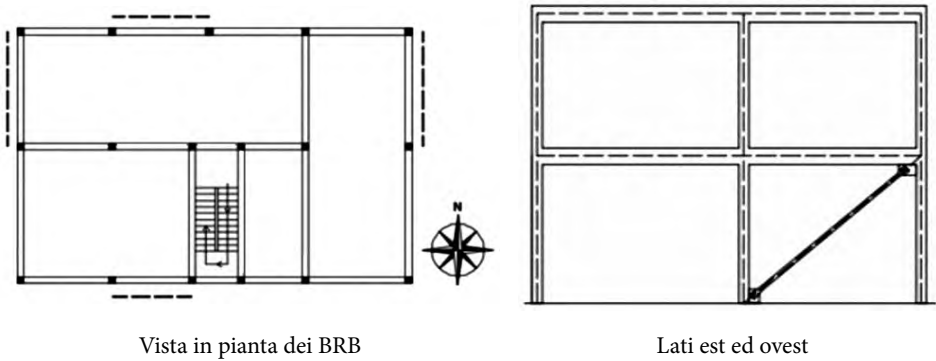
Posizionamento dei BRB in pianta ed in sezione sui lati est ed ovest
